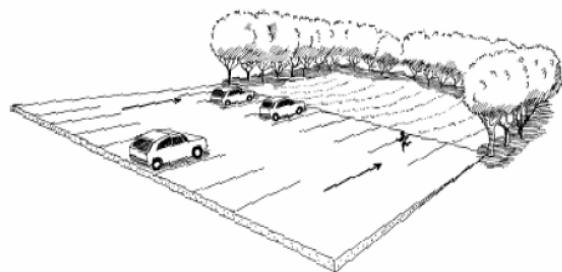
Pengaliran Air Hujan Ke Dalam Bermed Landscape
